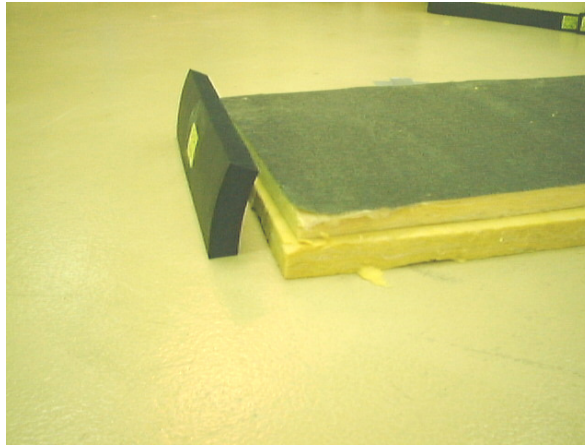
Placas de lã mineral utilizadas no pavimento falso
